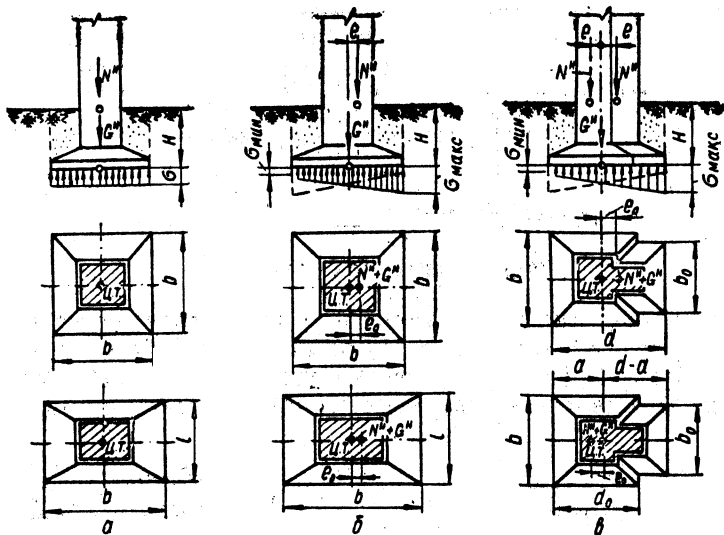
Расчетные схемы и эпюры напряжений под подошвой фундаментов:
